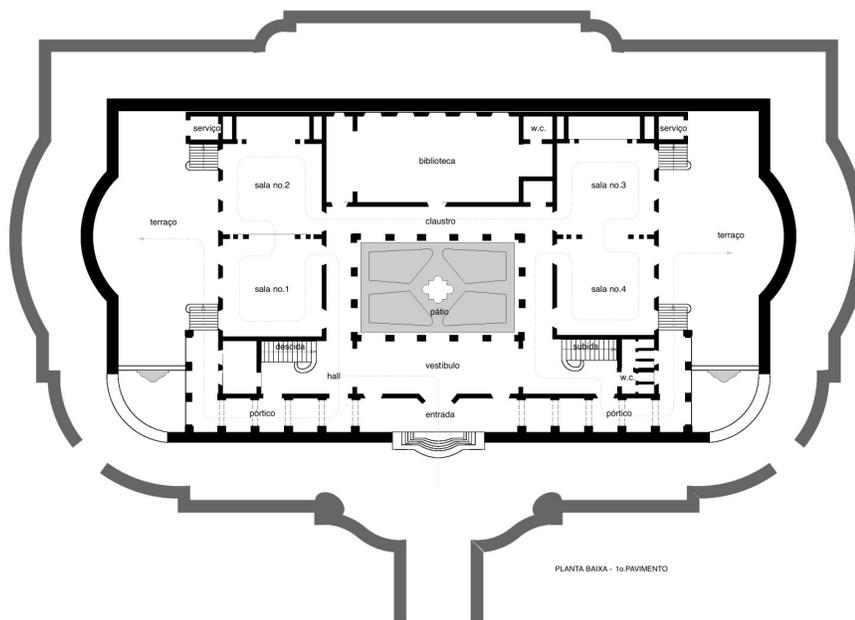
Planta baixa - 1o. pavimento - Projeto de Lucio Costa.
